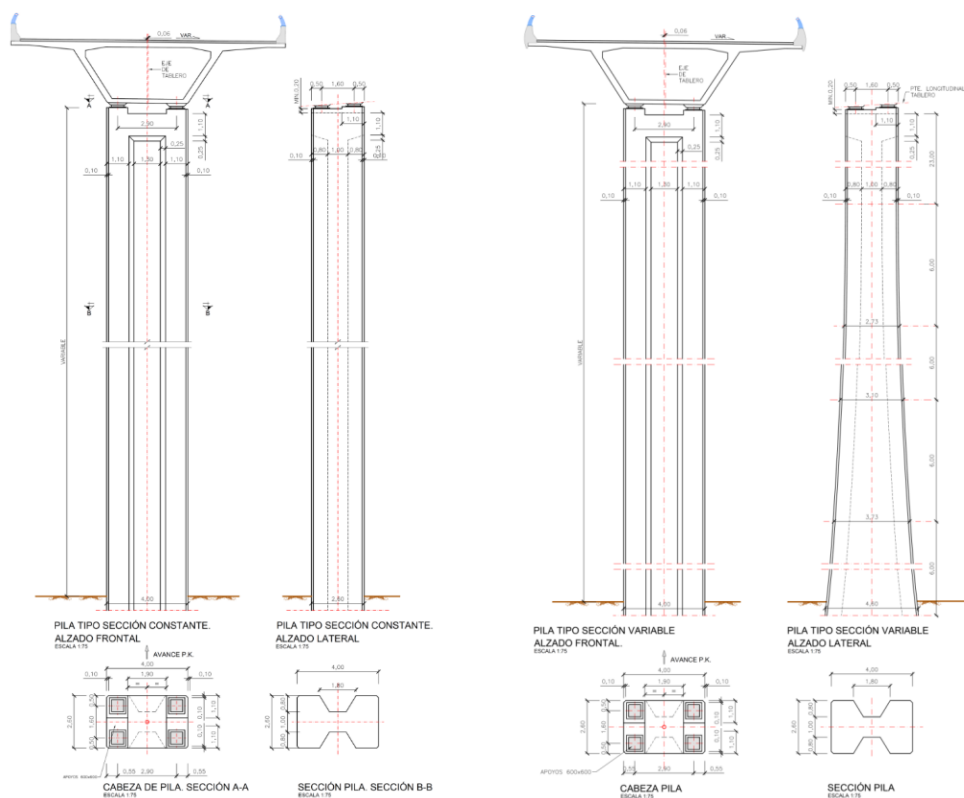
Pilas de sección constante y de sección variable. (Fuente: [5]).
